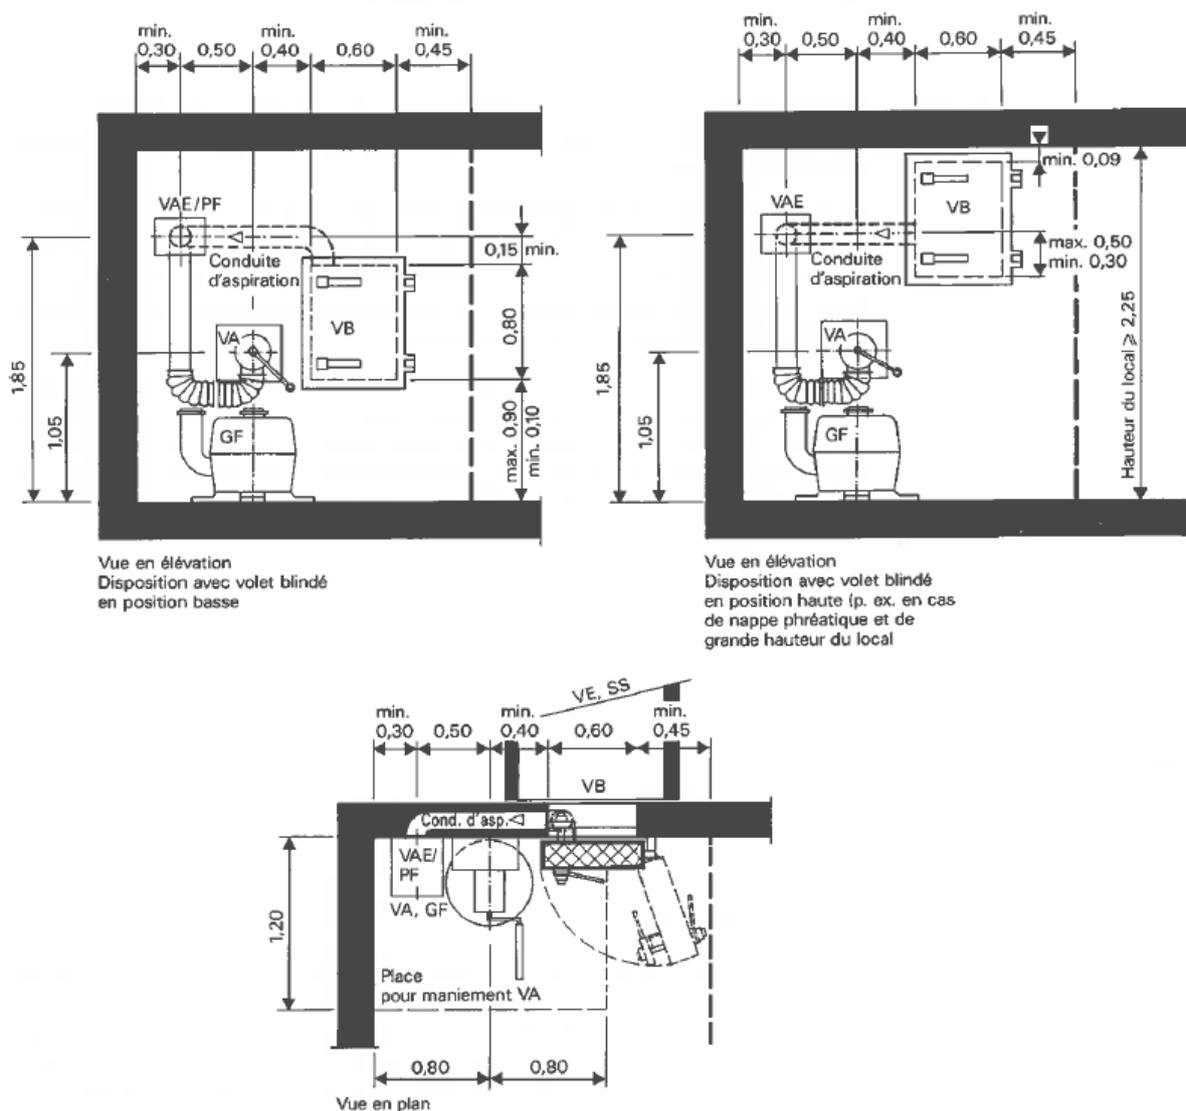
Disposition de VA et VB le long d'un mur
